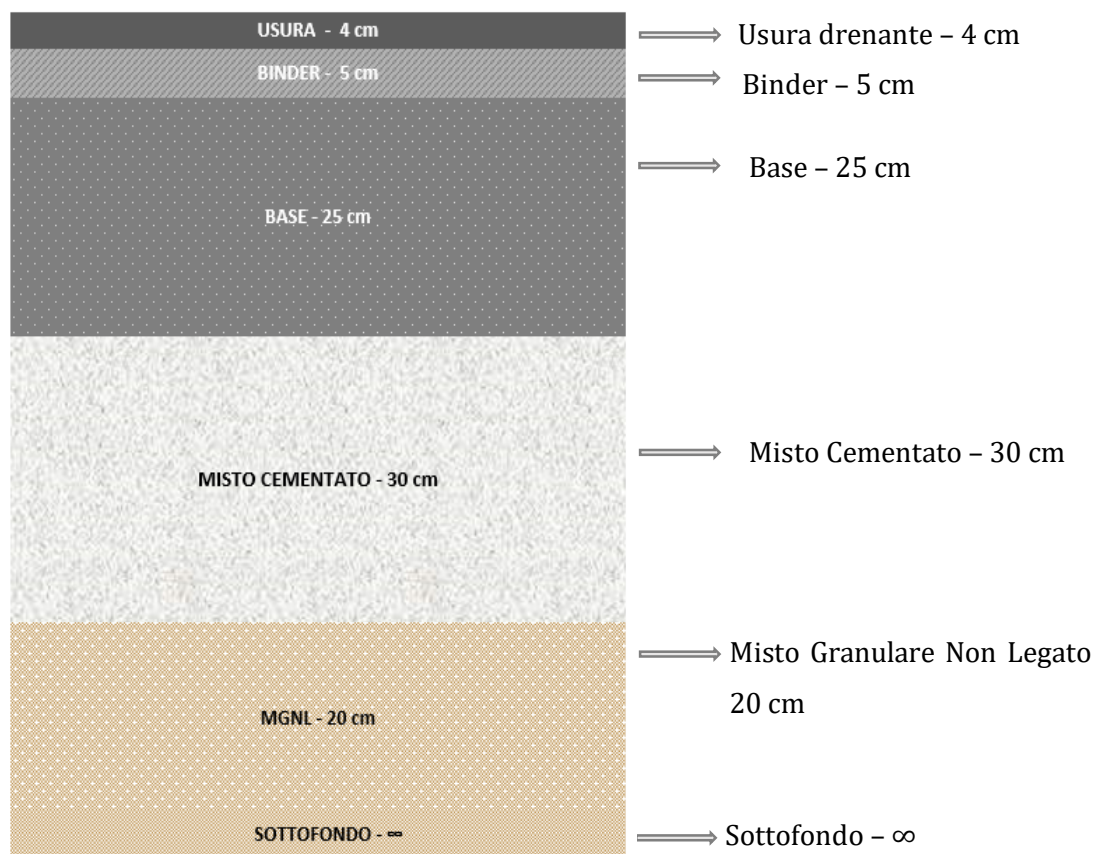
6. Schema del pacchetto pavimentazione utilizzato nel calcolo.
